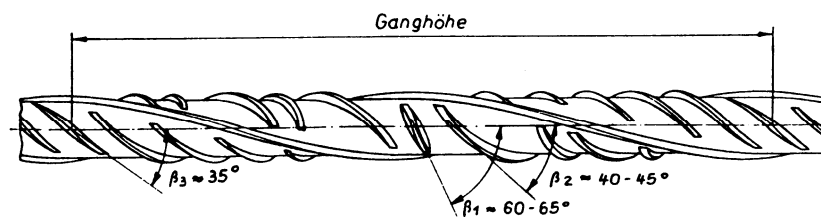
Kalt verwundener Betonstahl BSt 500 S
